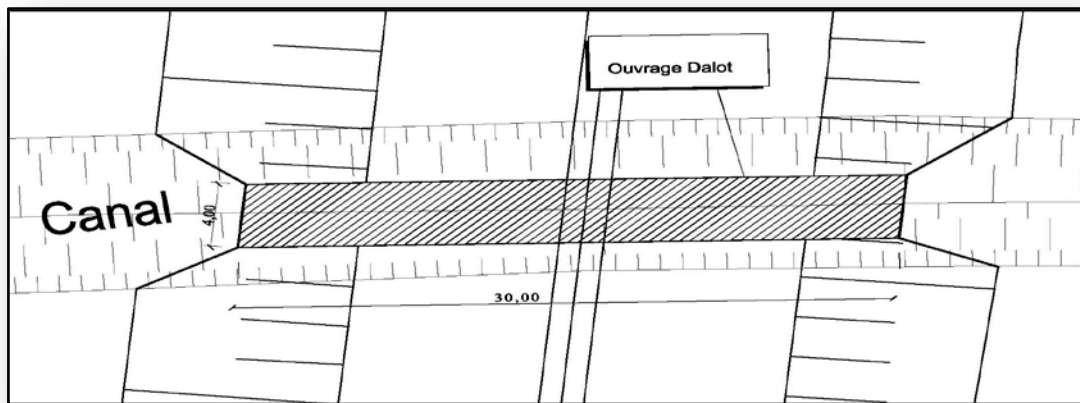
Vue en plan de l'ouvrage.
